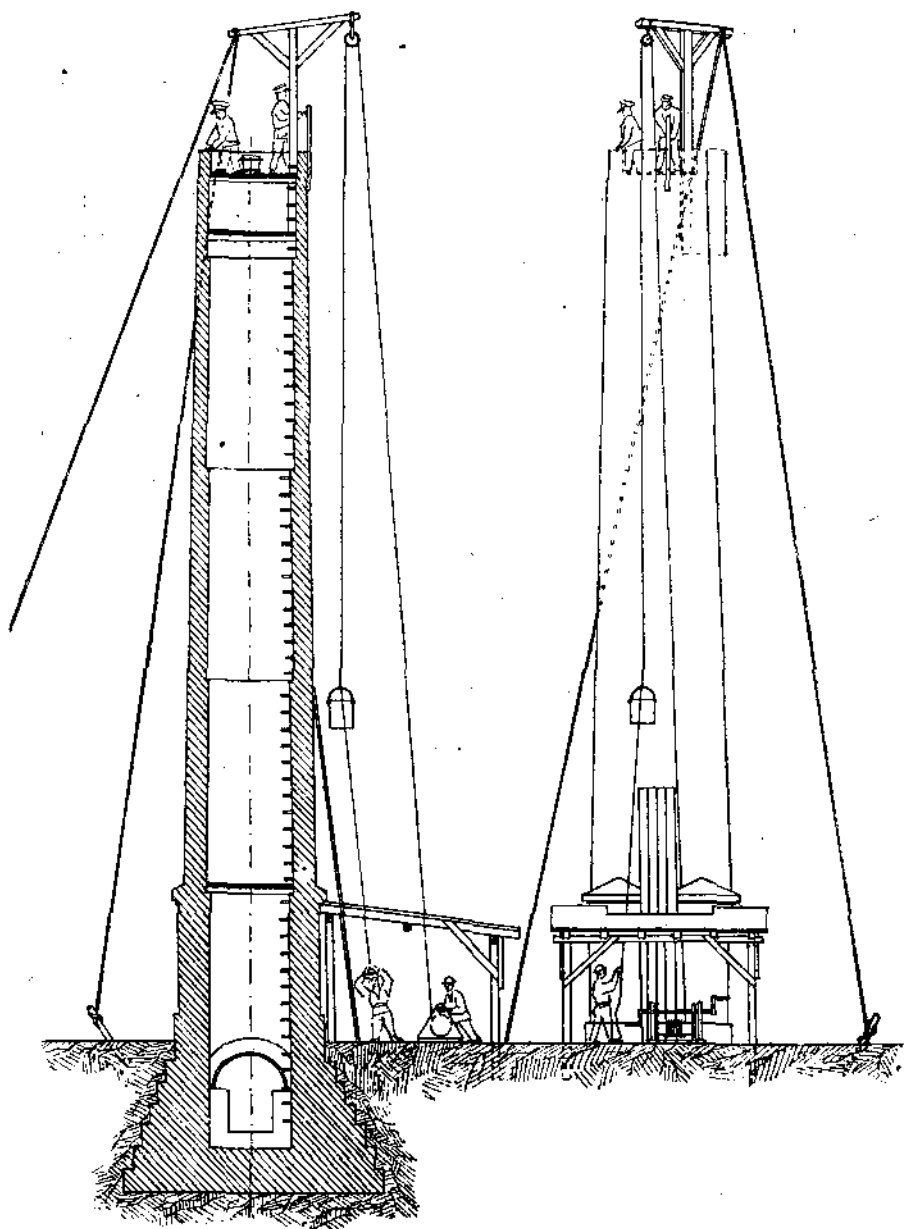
Приспособление для опалубки железобетонных колонн.
